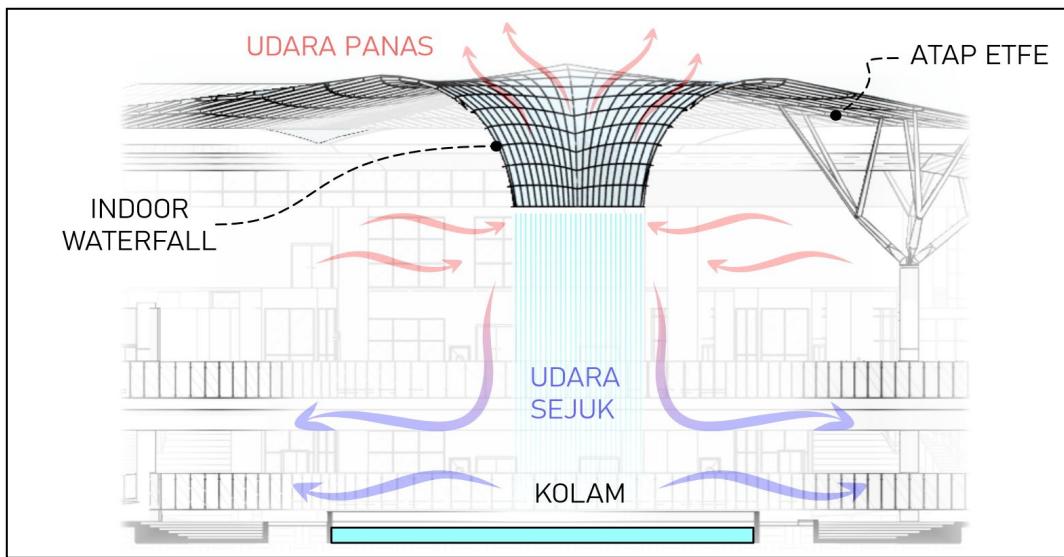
Skematis penerapan ventilasi silang pada bangunan Stasiun Parangloe
